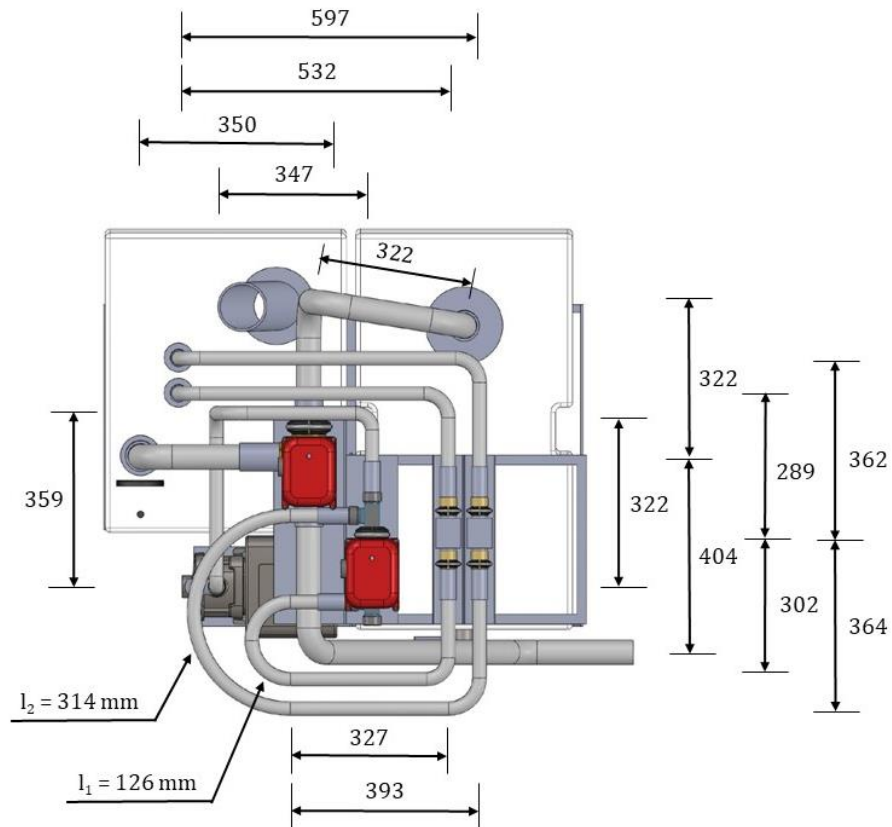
Comprimento aproximado de canalização no plano horizontal (medidas em mm).
